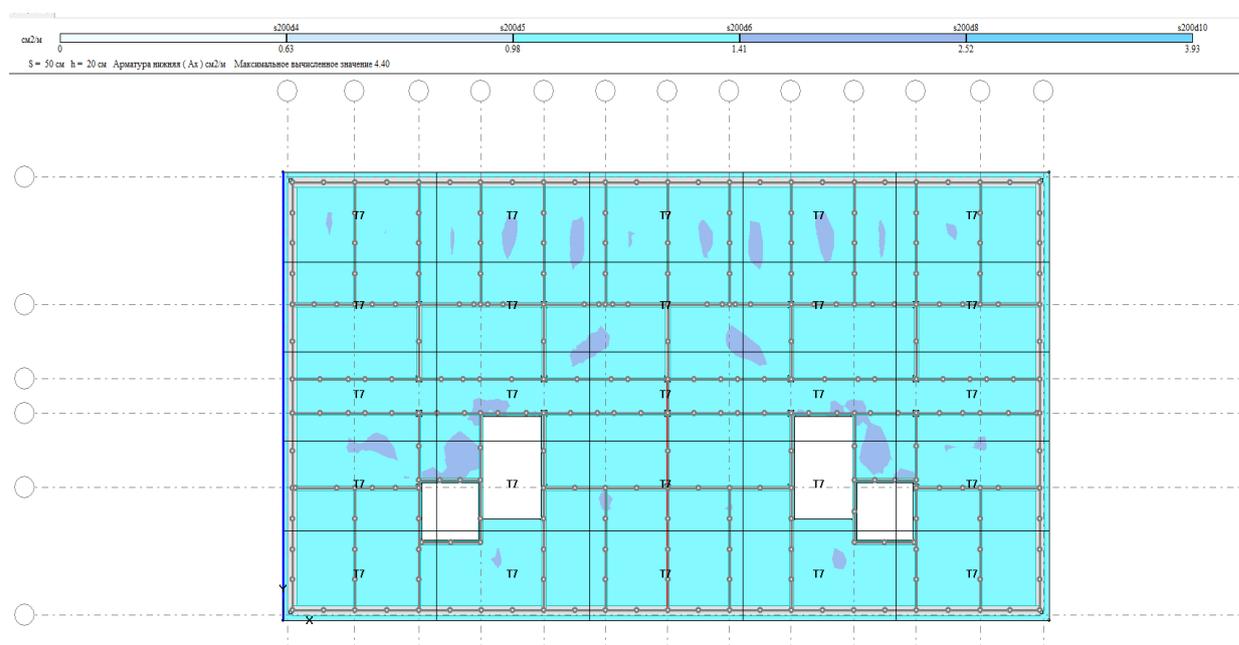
Задание контуров армирования плиты перекрытия (нижнее армирование)
